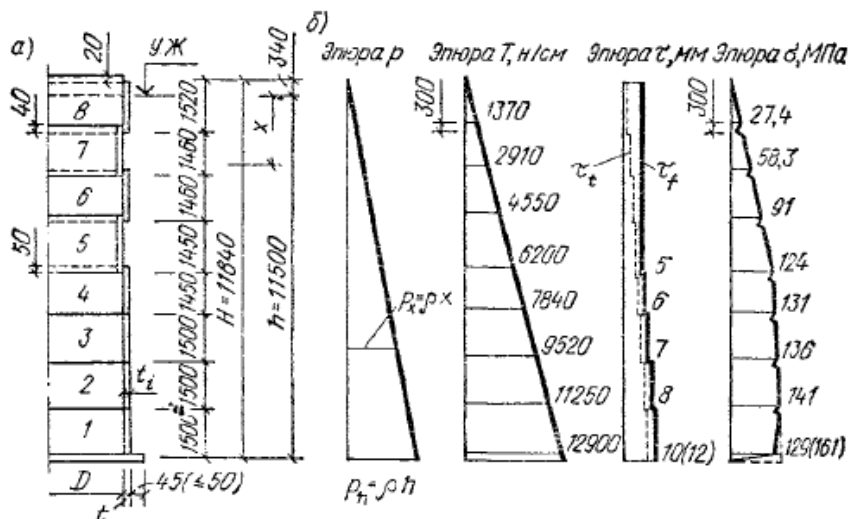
Розрахунок стінки вертикального циліндричного резервуара:
